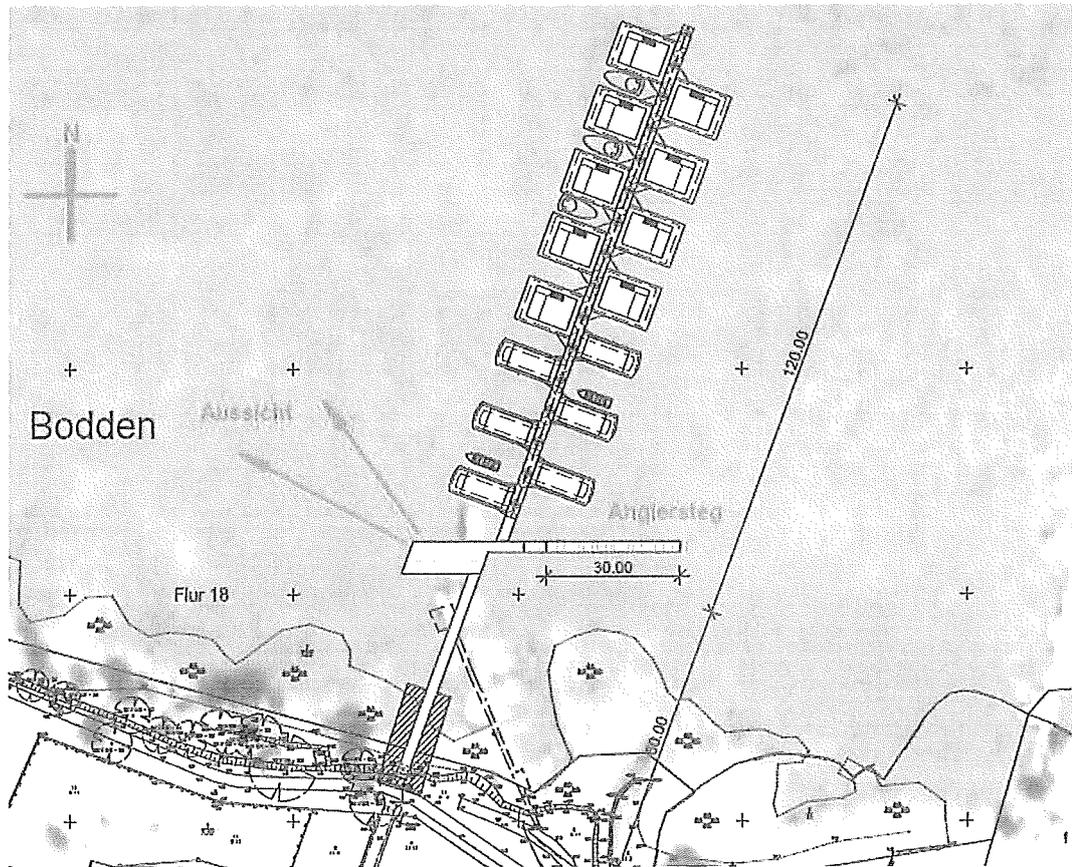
Lageplan geplante Stegananlage mit schwimmenden Ferienhäusern
